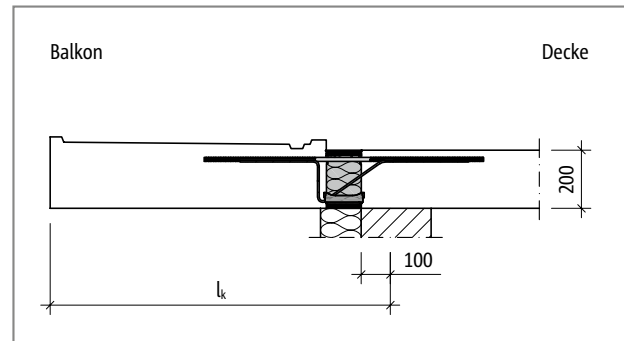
Schöck Isokorb® CXT Typ K: Statisches System
